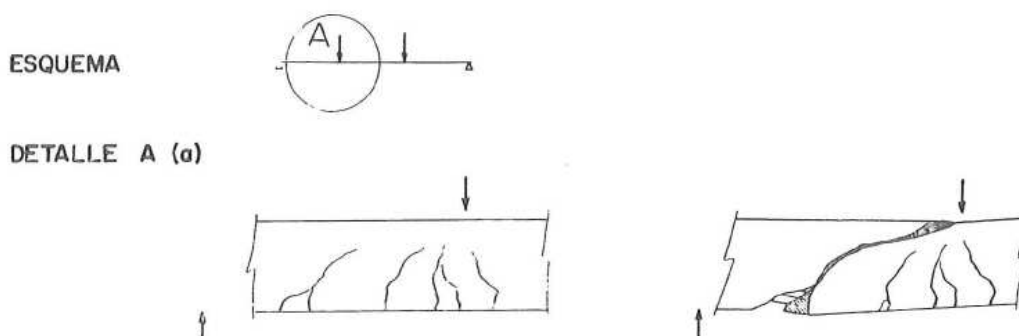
Progreso de la fisuración hasta rotura en viga de sección rectangular pretensada sin armadura transversal (Sozen)
